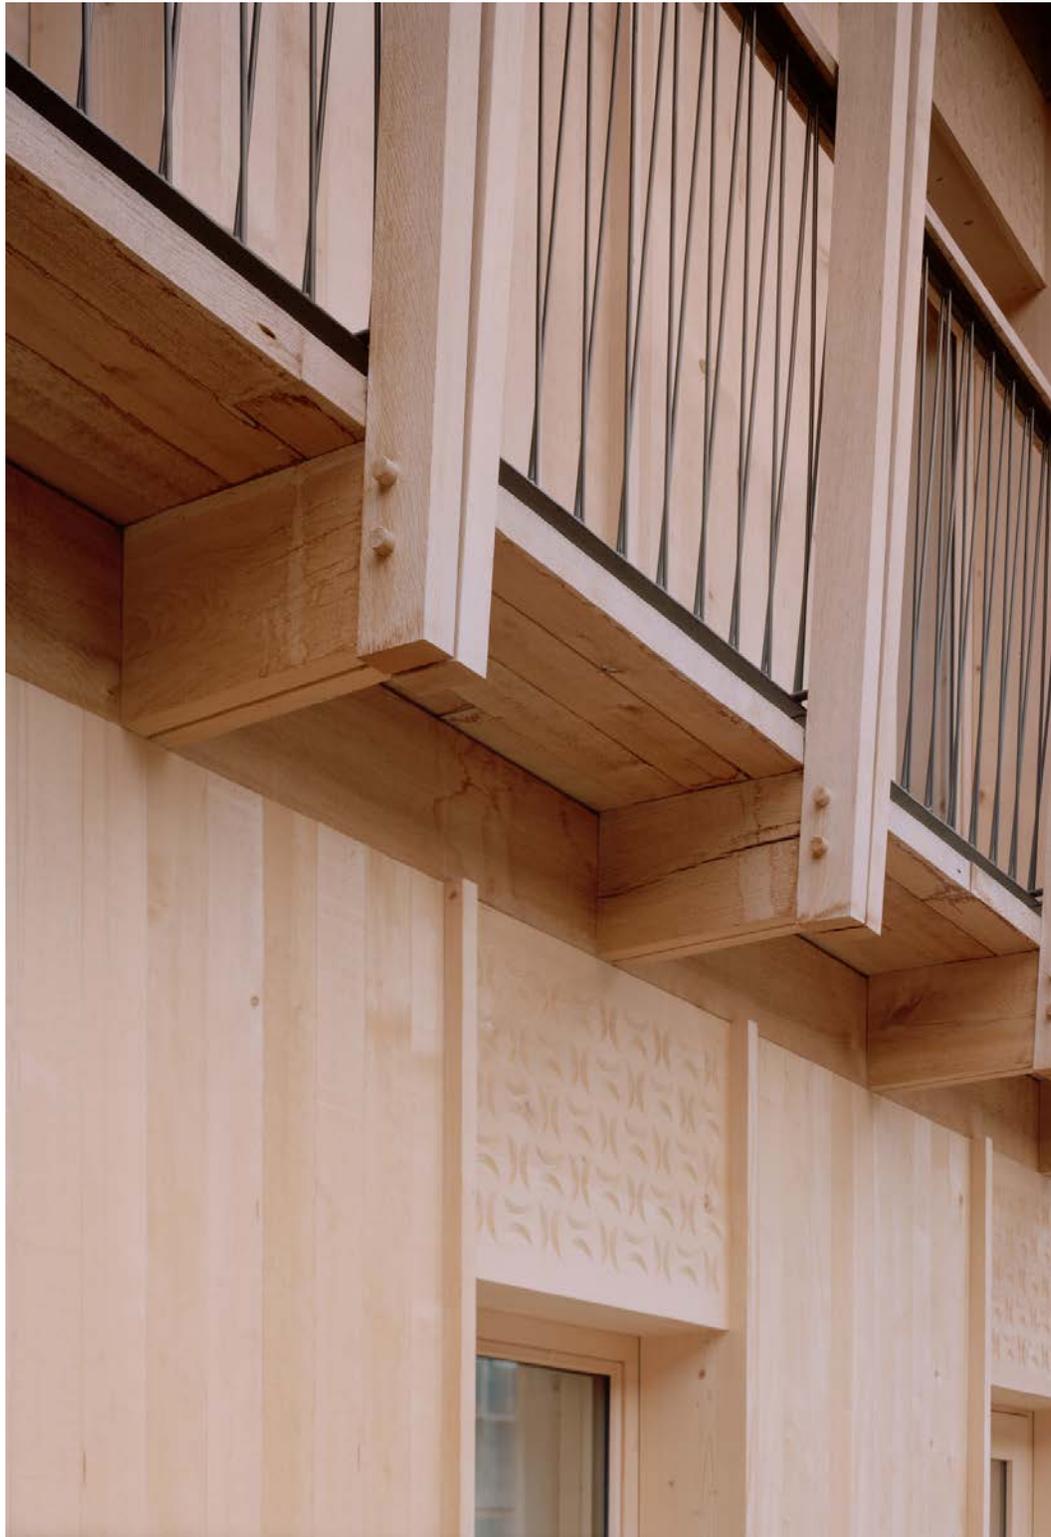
Fassade des Bürohaus Küng mit sichtbaren Holzpurelementen.
